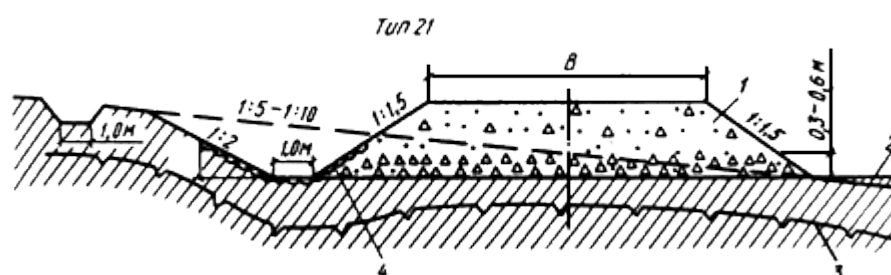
Поперечный профиль насыпи на неустойчивом склоне: 1 - грунт насыпи; 2 - кавальер удаленного грунта; 3 - ВГВМ после постройки насыпи; 4 - укрепление каменной наброской нижней части нагорного откоса и площадки между его подошвой и откосом насыпи
